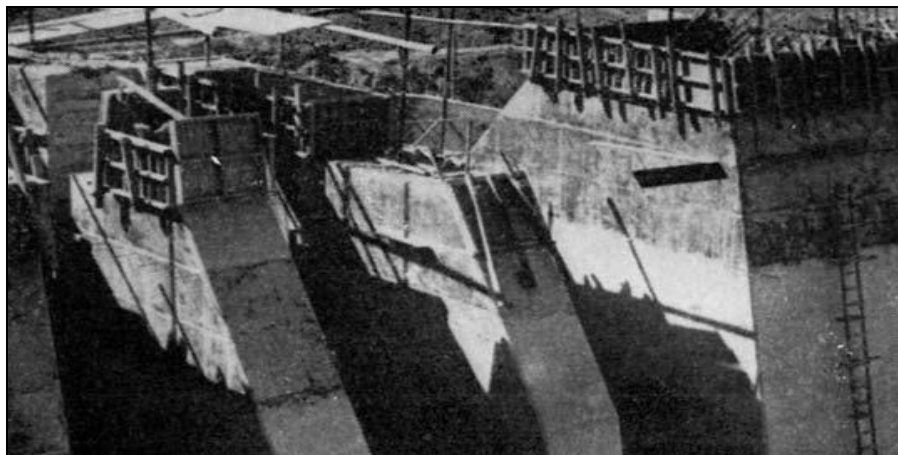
Port de Casablanca (Maroc, 1954-55) Construction de la forme radoub et du bassin d'armement.
